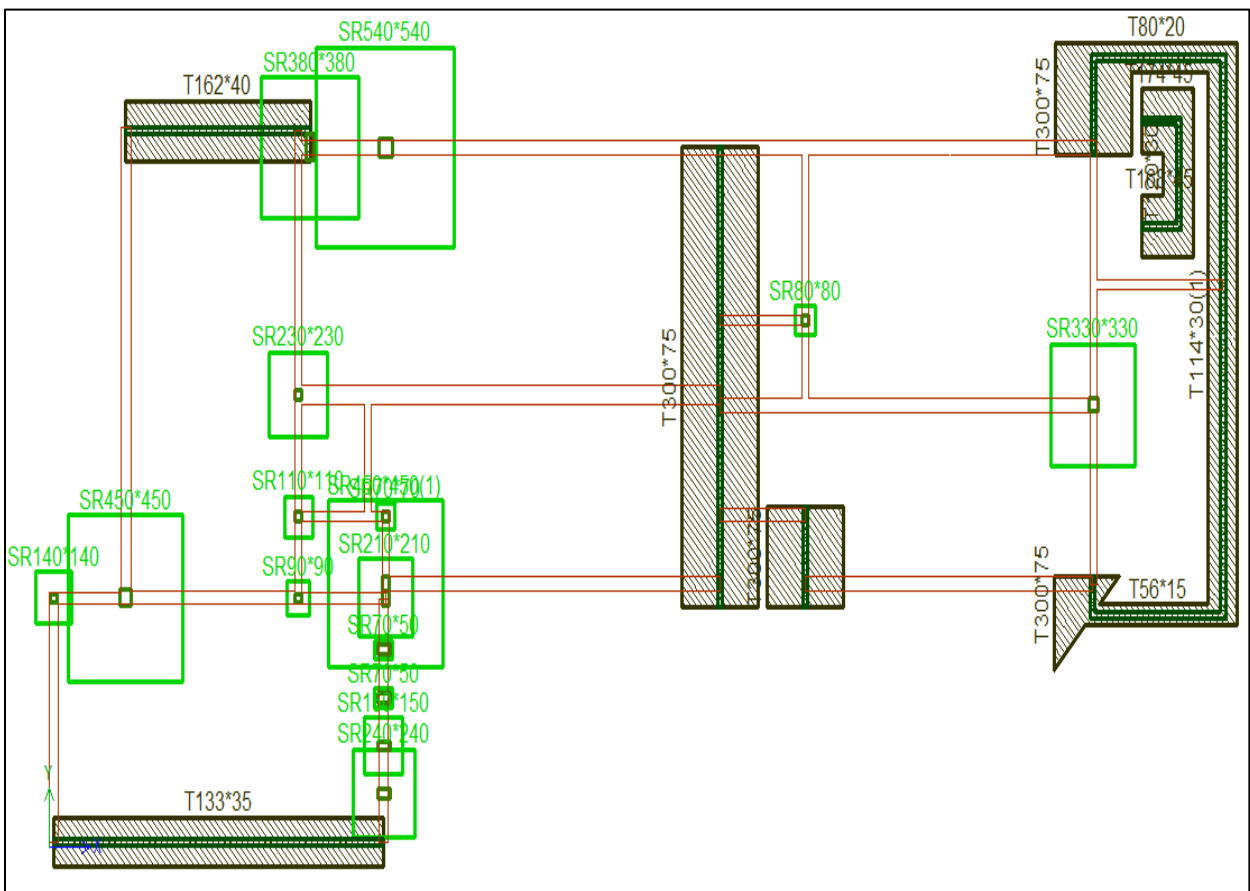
Pré-dimensionnement des semelles du RDC, Tranche 2.
